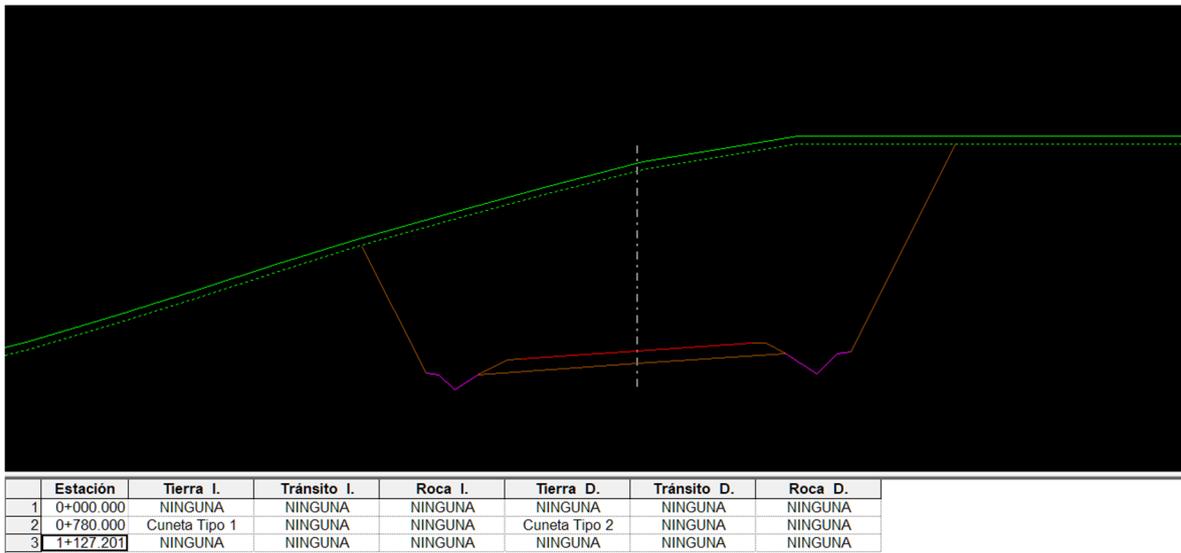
Sección transversal del Eje 1 donde se observan las cunetas y su tabla de asignación en la parte inferior
